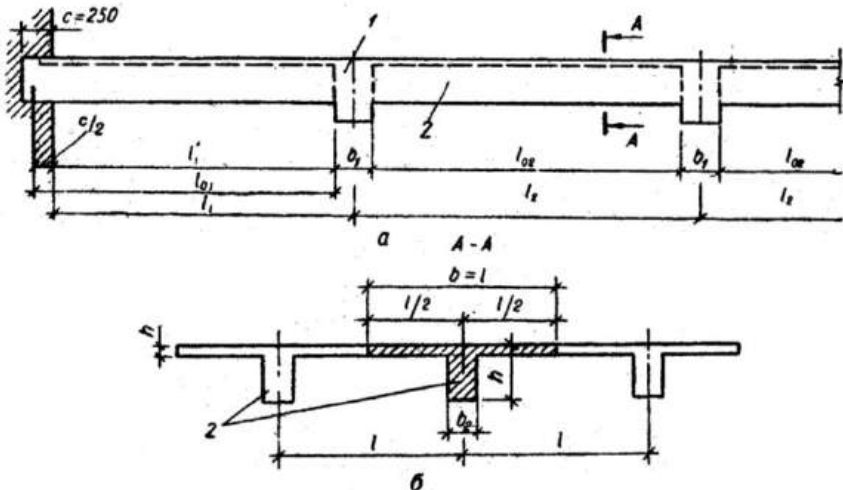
До розрахунку другорядних балок: *a* – розрахункова схема; *b* – розрахункові прольоти і розрахункова смуга, з якої збирають навантаження на другорядну балку; 1 – головна балка; 2 – другорядні балки
